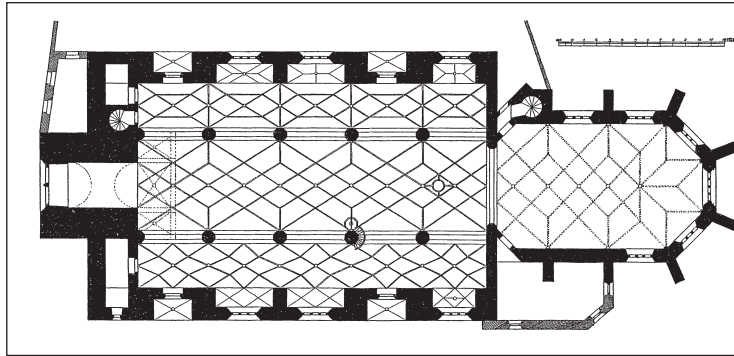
Grundriss der Frauenkirche nach R. HEILIGENTHAL 1909 (Anm. 10).
